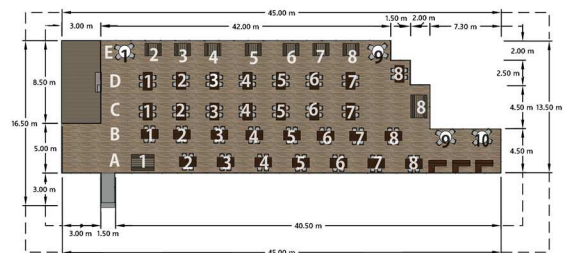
Layout Titik Lampu Resto dan kafe Pondok Santai Tanjungpinang
